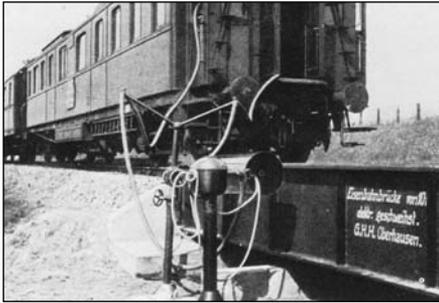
Durchstrahlungsprüfung an elektrisch geschweißten Bauteilen einer Eisenbahnbrücke
